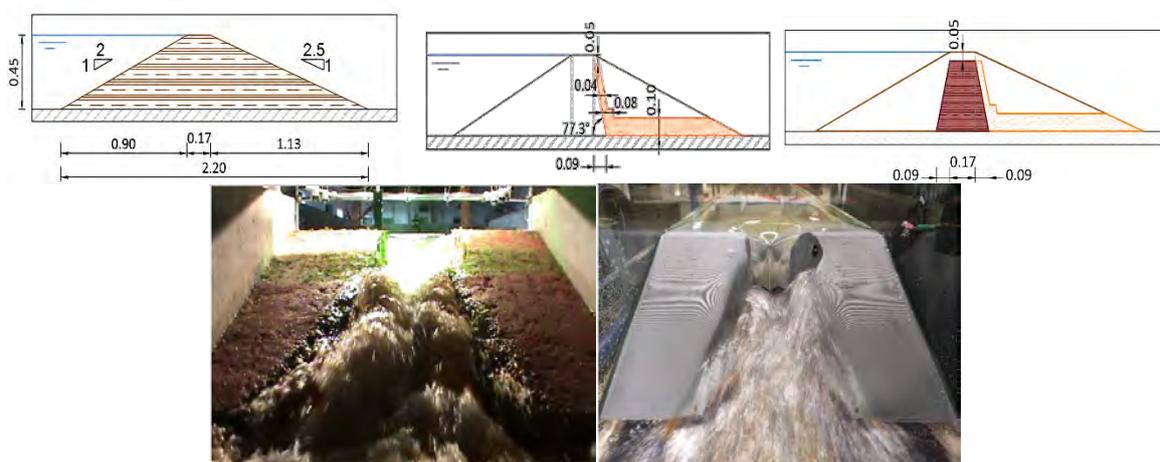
Aspetos do projeto Dam & Dike Care: secção transversal-tipo das barragens ensaiadas (em cima); vista frontal de ensaio com modelo de aterro para caracterização geotécnica da rotura e vista de ensaio com brecha impressa em PLA para caracterização da hidrodinâmica da rotura (em baixo)
